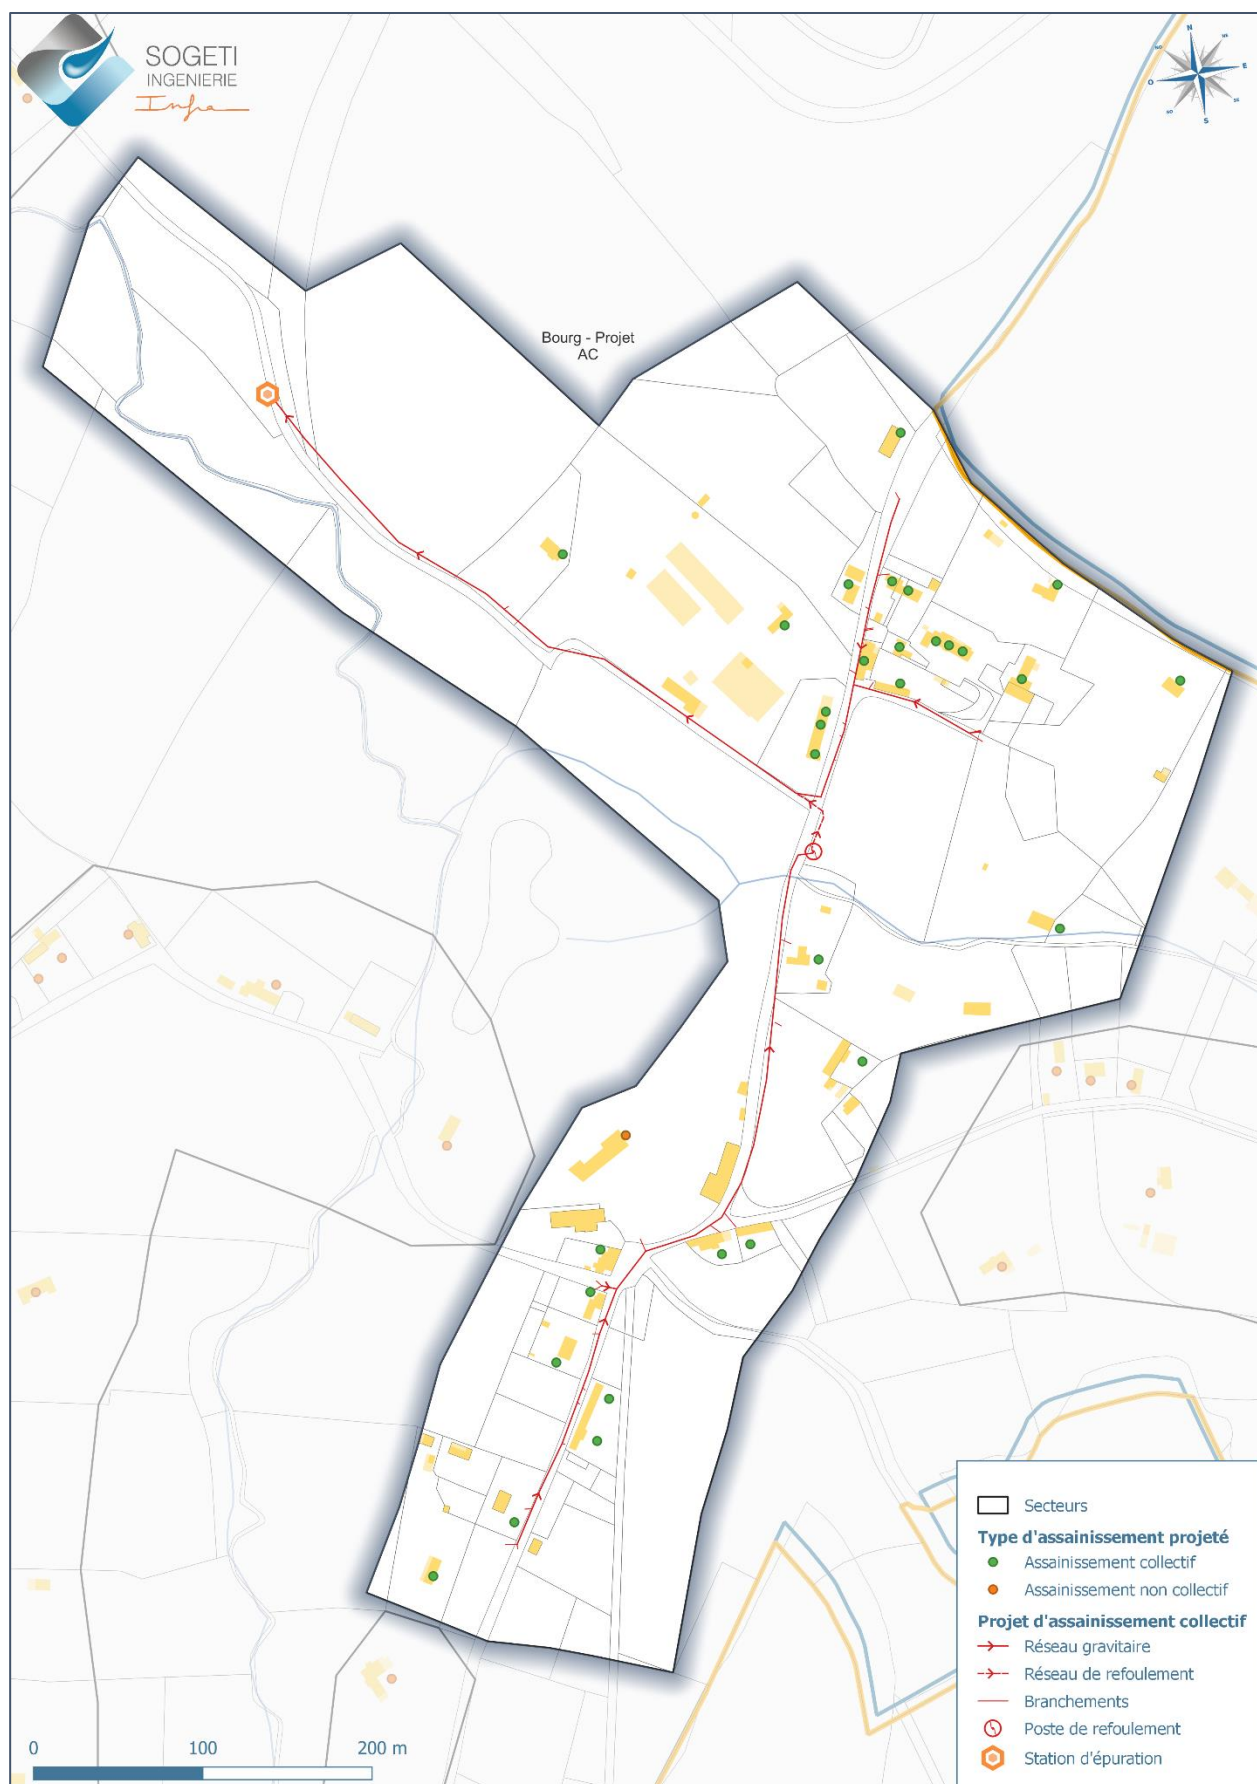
Projet d'assainissement collectif sur le bourg de Barneville-la-Bertran
